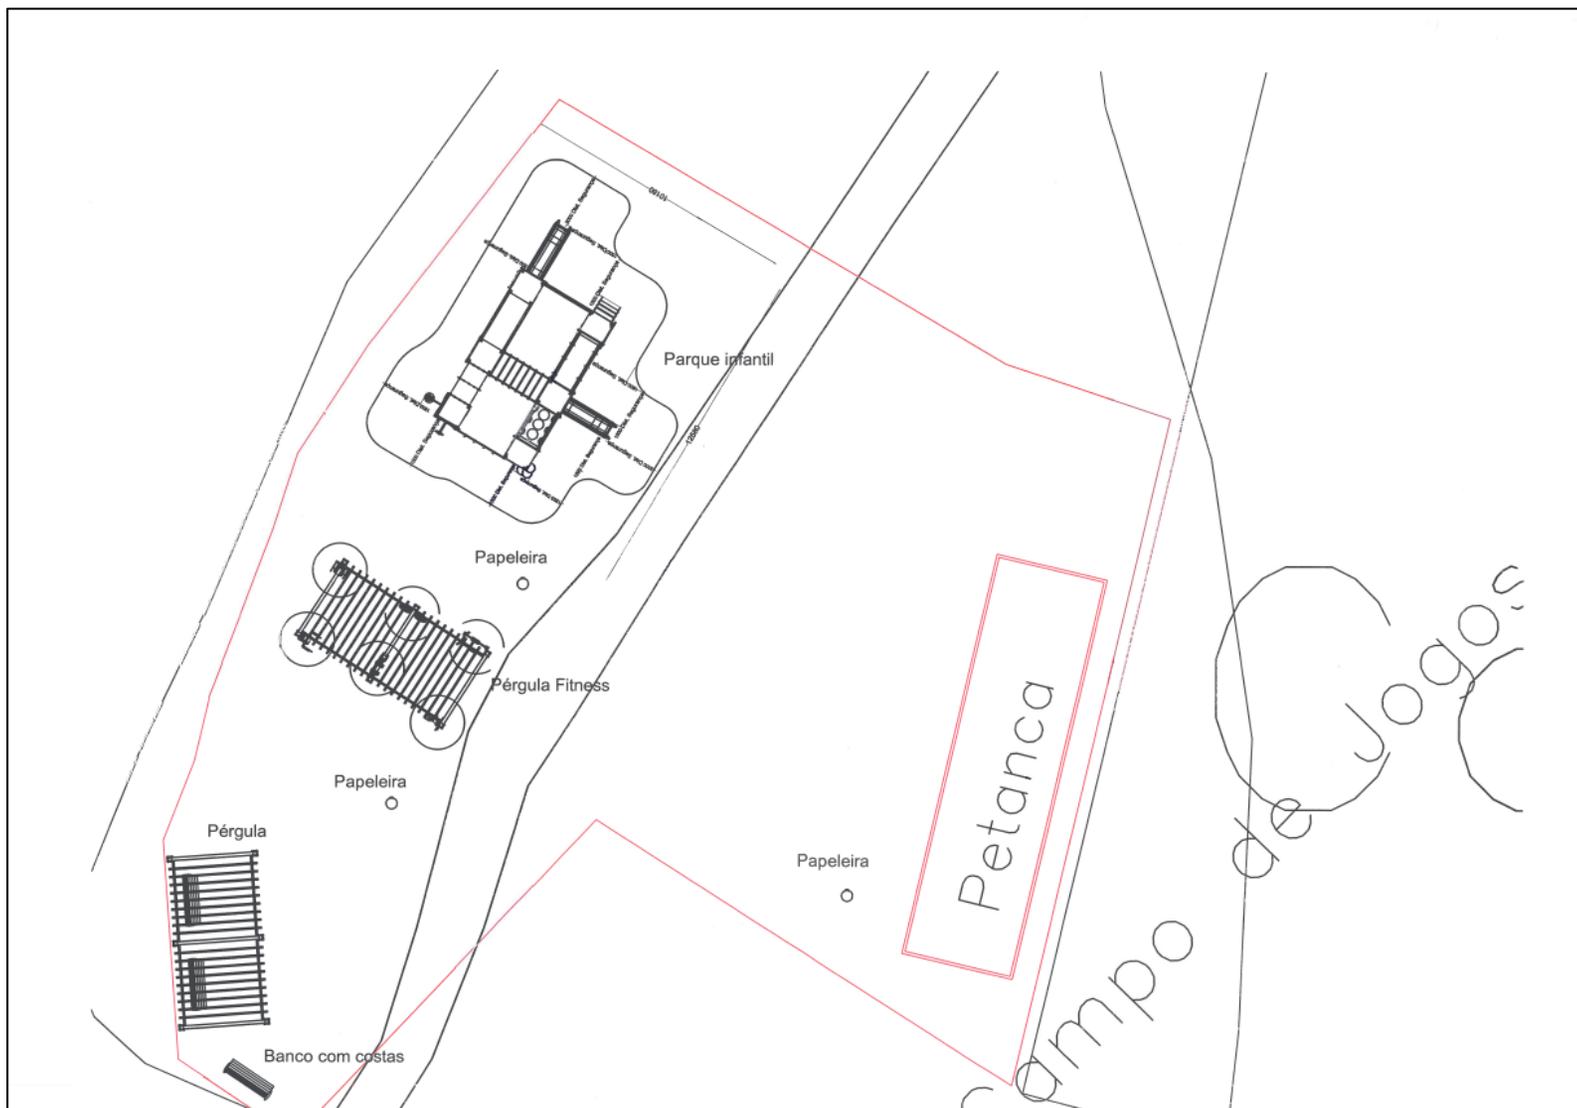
Planta do terreno e localização dos equipamentos que propomos instalar
